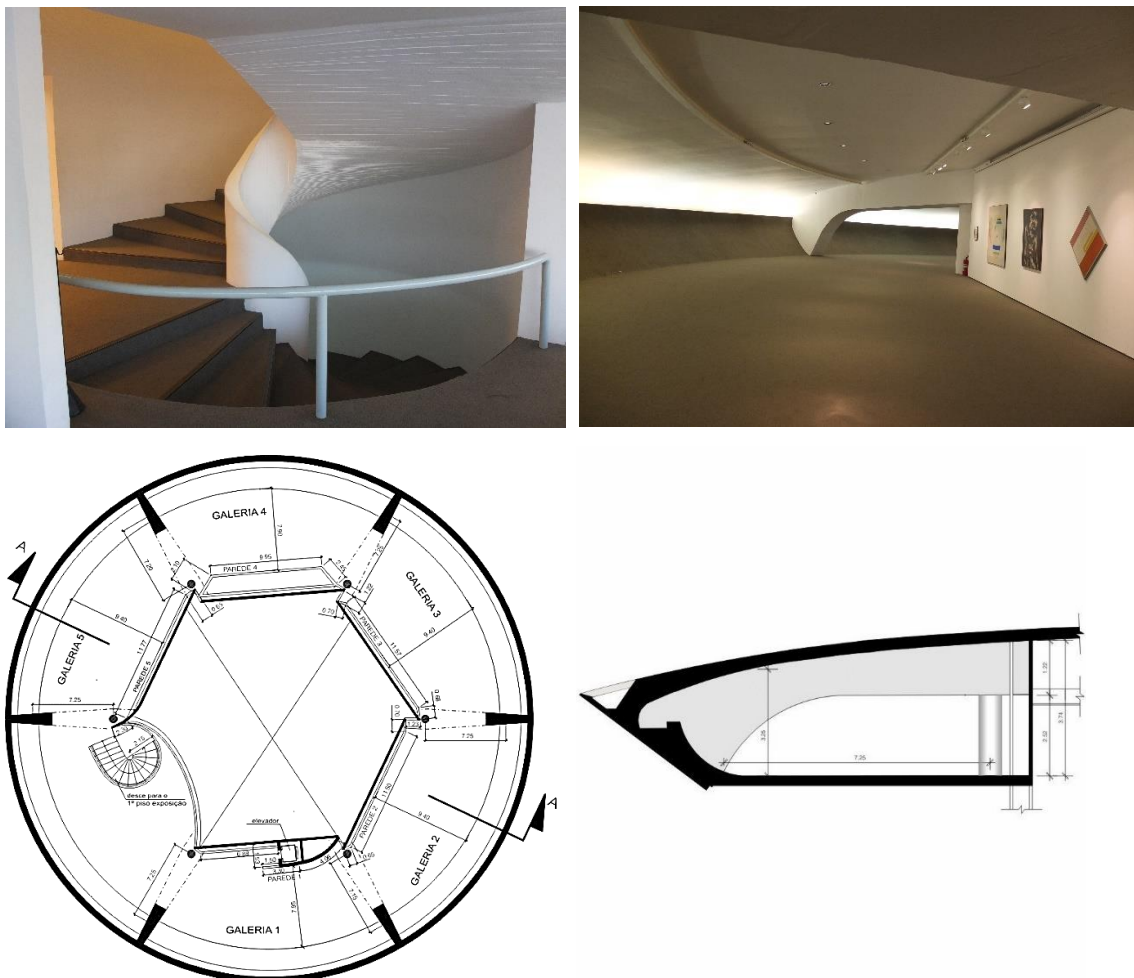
Segunda planta: Interior de la sala principal, corredor perimetral, planta y sección
